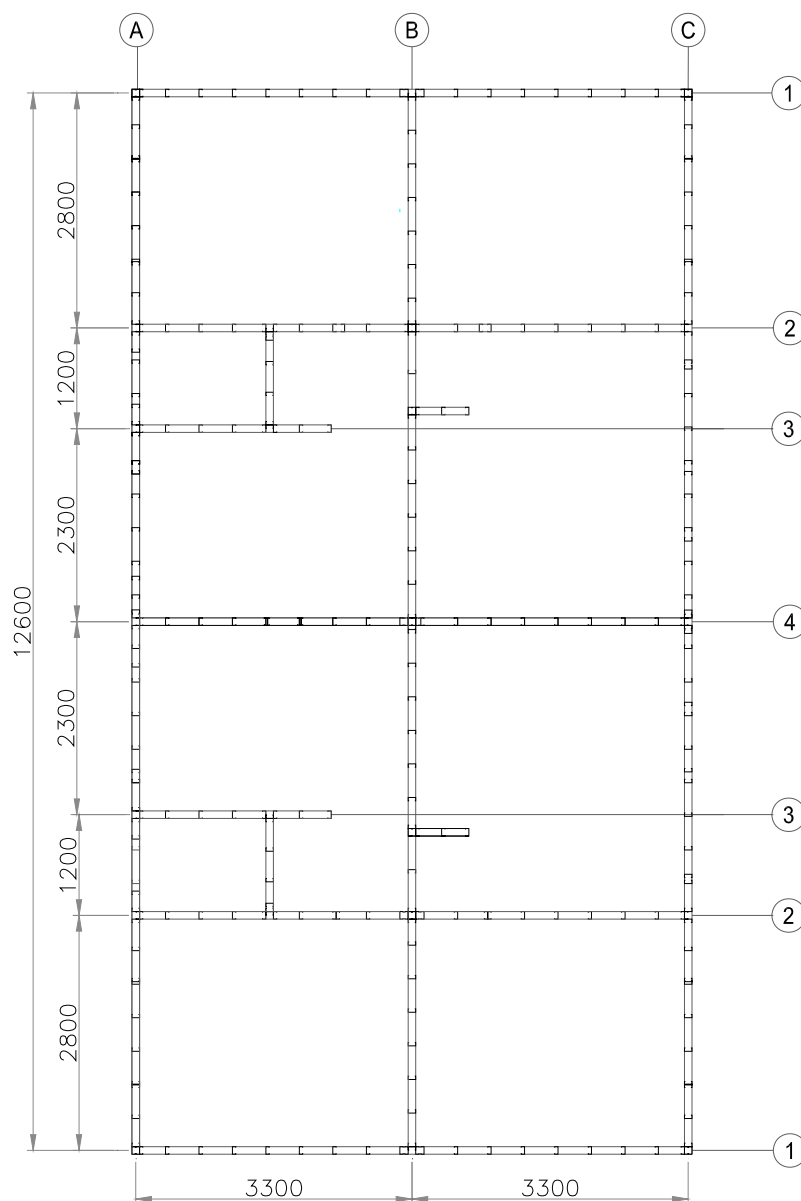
Posição dos montantes, com localização de Eixos e Filas estruturais. Arquitetura “A” com espaçamento de 400mm (metade de um pavimento).
